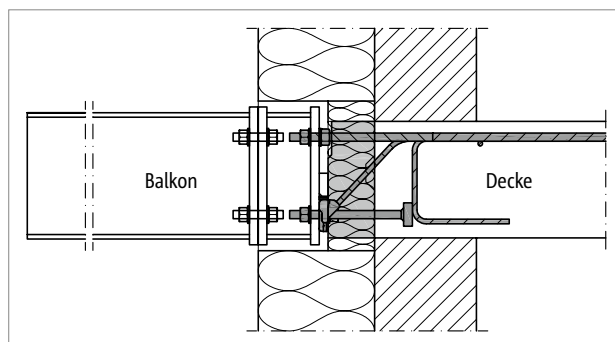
Schöck Isokorb® T Typ SK: Anschluss des Stahlträgers an einen Adapter, der die Dicke der Außendämmung ausgleicht
